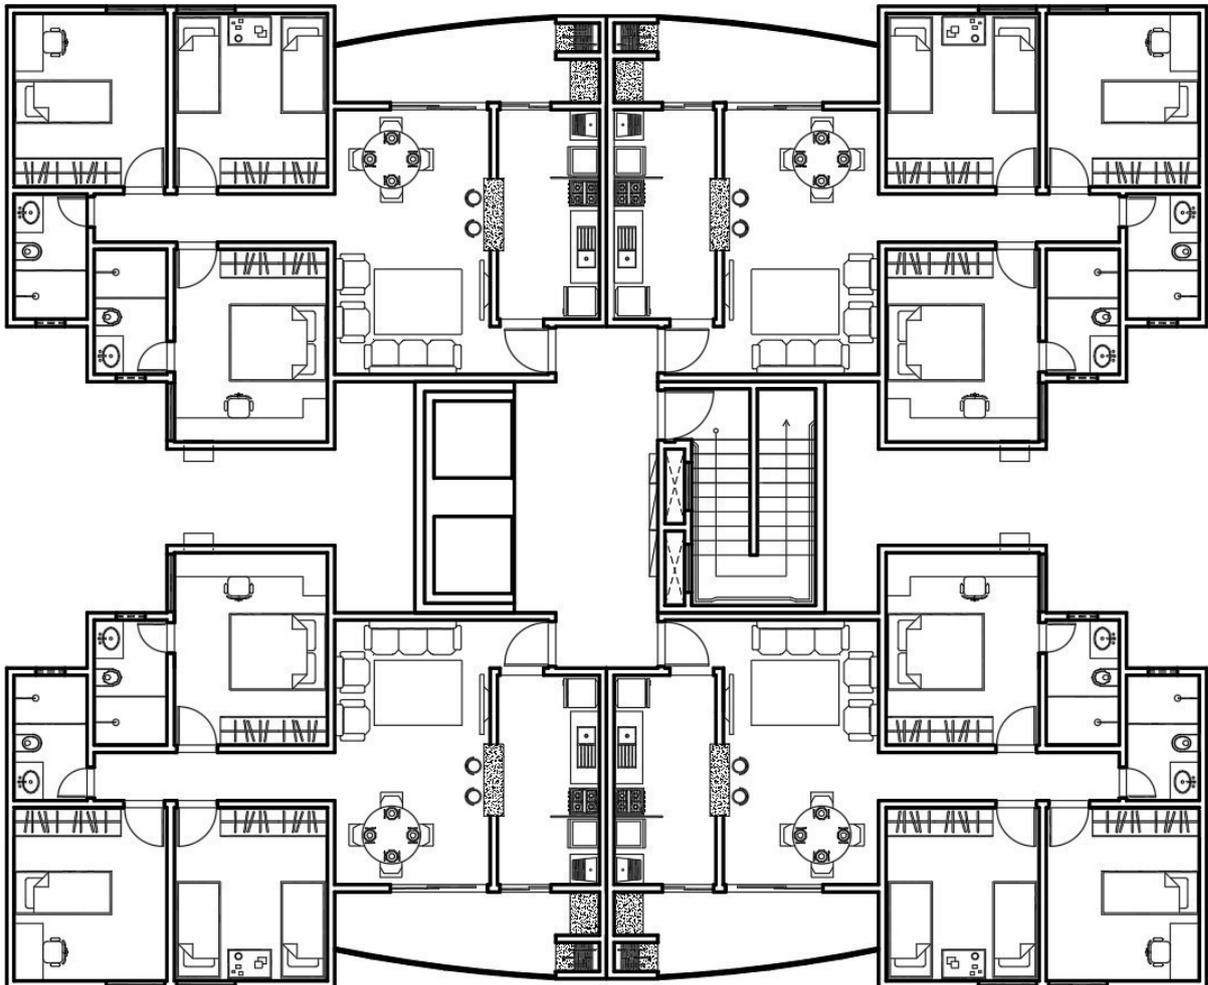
Planta baixa de pavimento tipo com quatro apartamentos (Autor, 2023).
